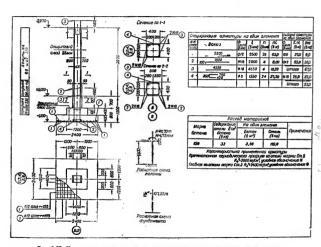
Қонструкция колонны н фундамента (варнант армирования вязаной арматурой).
